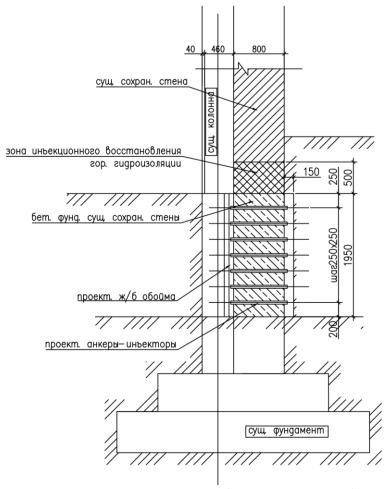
Узел I. Усиление фундаментной балки с устройством железобетонных шпонок (Чертеж автора)
